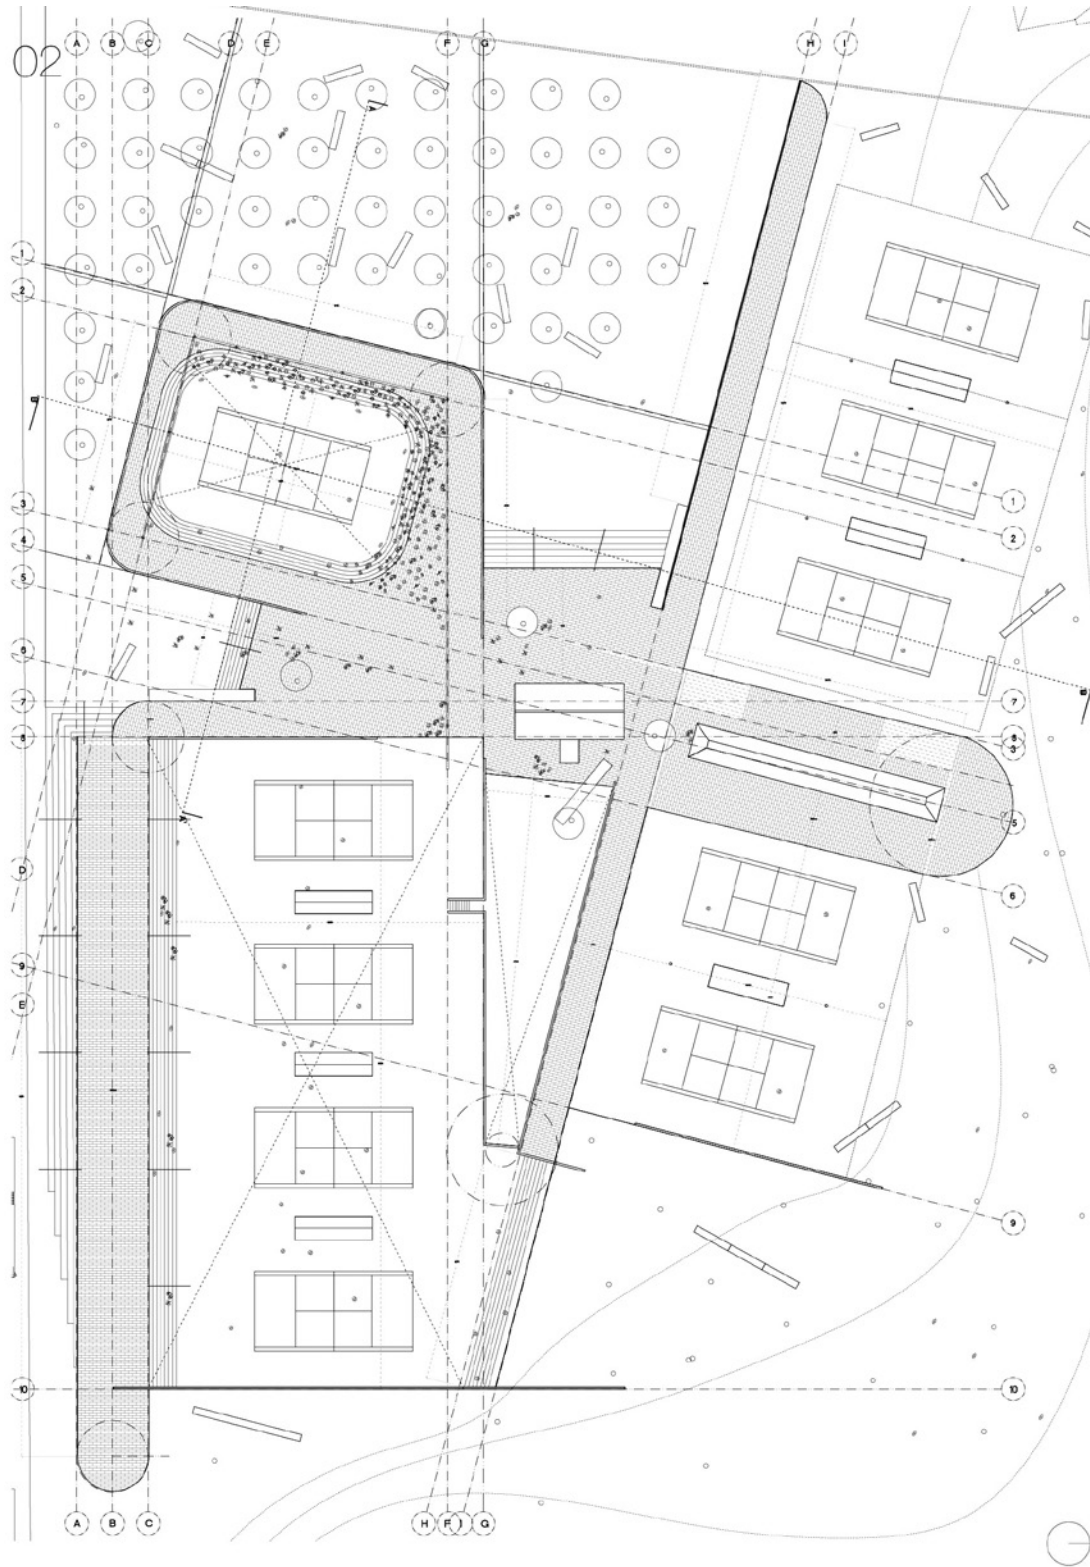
Planta de zócalo de conjunto deportivo. Fuente: elaboración propia.
